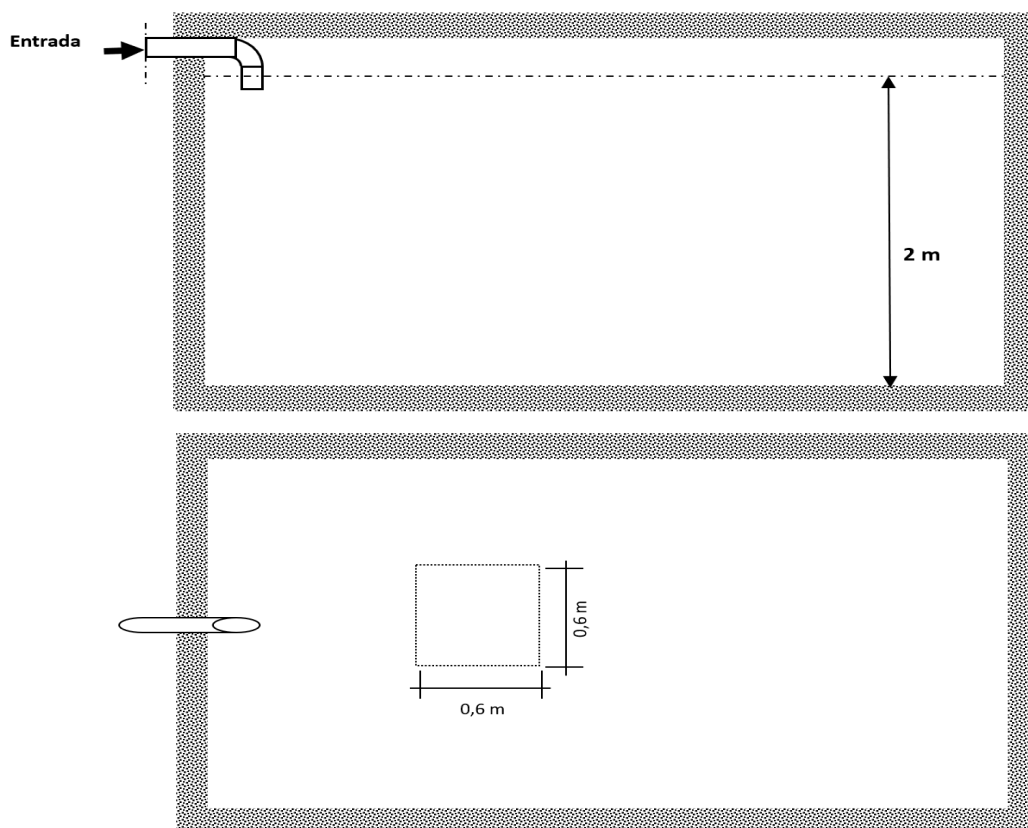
Fossa séptica - Planta e Corte Longitudinal
